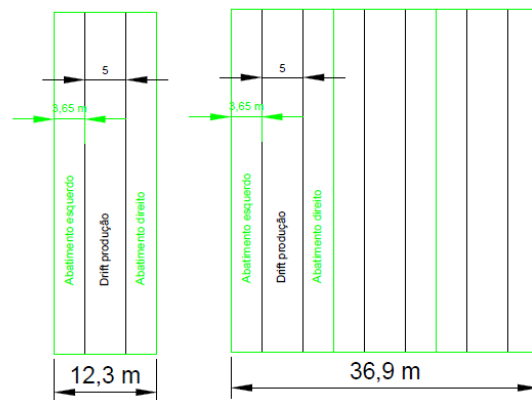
Esquematização em planta das larguras de bancada, em sistema individual e trifurcação calculadas.
